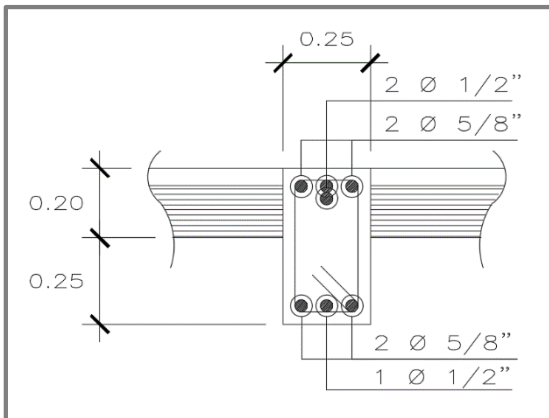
Detalle del acero longitudinal de la Viga 25X45-corte 2-2
